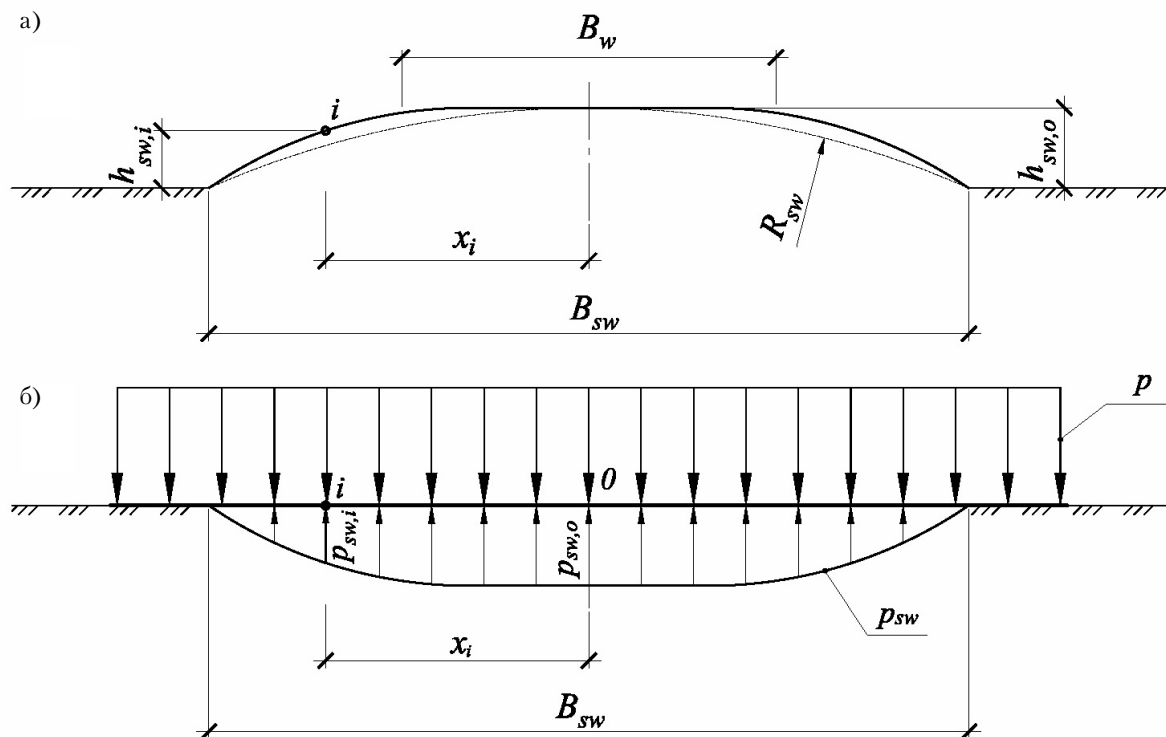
Воздействие на фундамент со стороны набухающего грунта: а) подъем грунта при набухании незагруженной поверхности; б) расчетная схема эквивалентной нагрузки при набухании грунта и $p > p_{sw,0}$.
